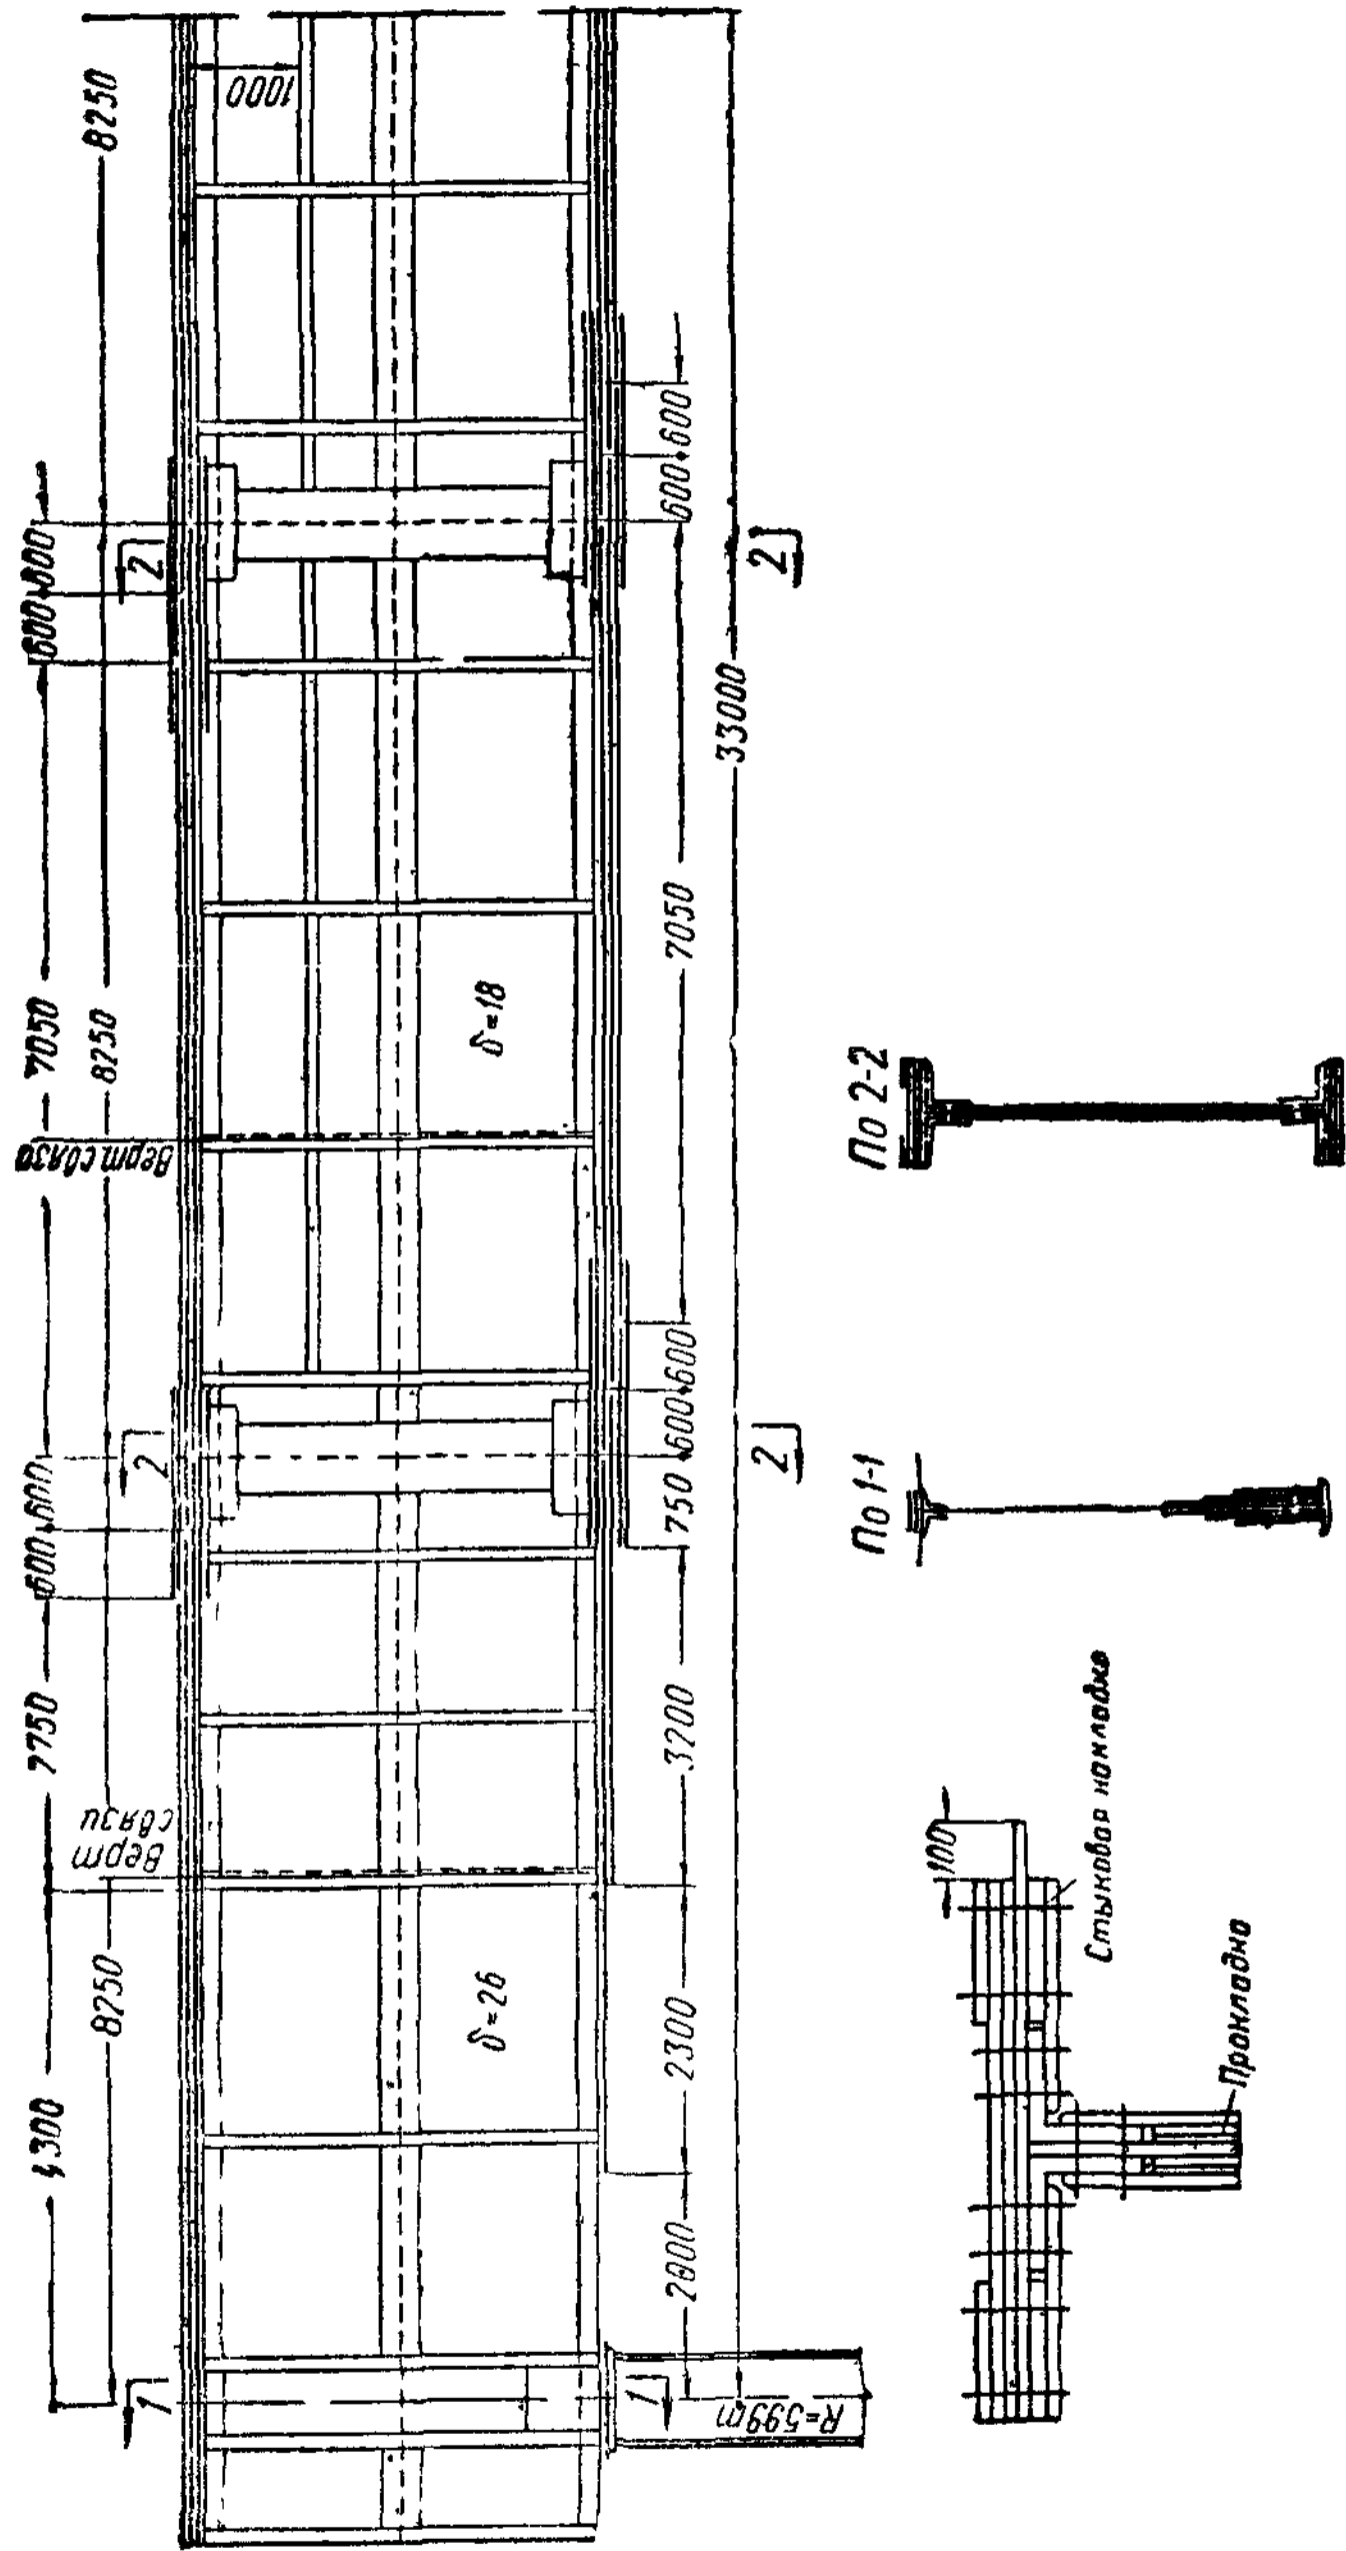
Конструкция тяжелой клепаной подкрановой балки и несимметричное перекрытие стыка горизонтальных листов пояса
